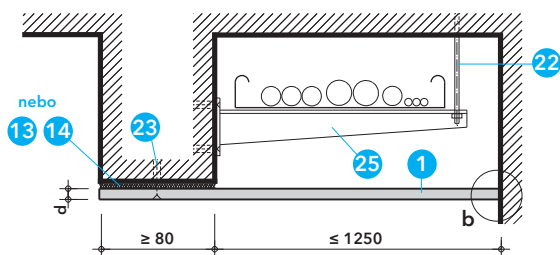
průstup instalačního kanálu lehkou příčkou
